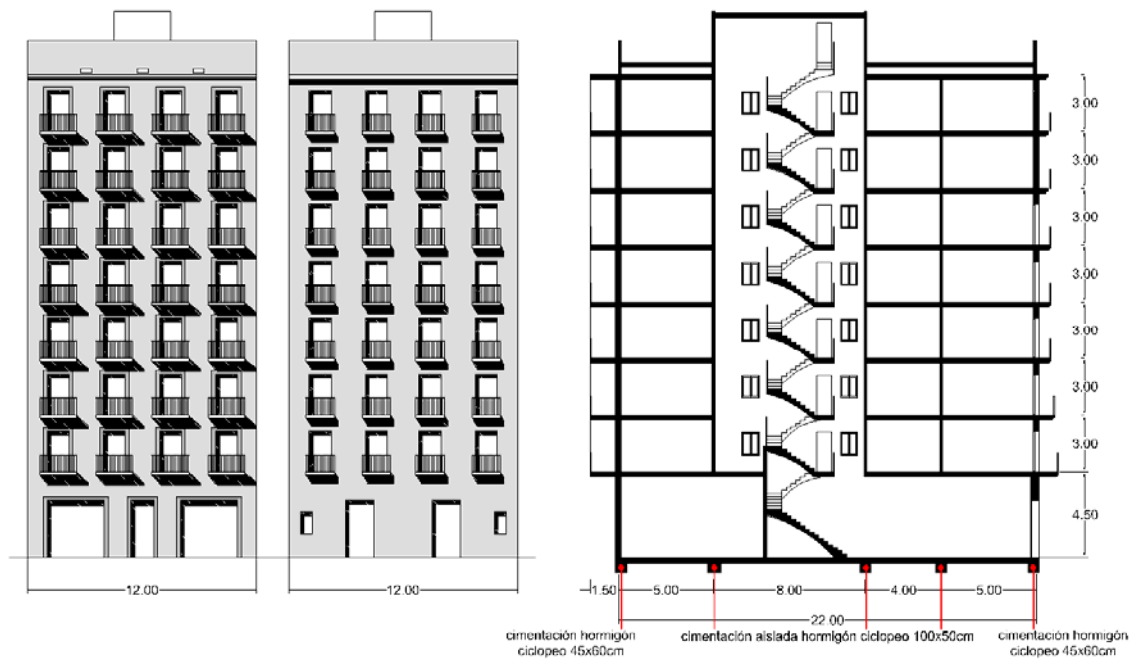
f Plantas, alzados y sección del modelo II.7
